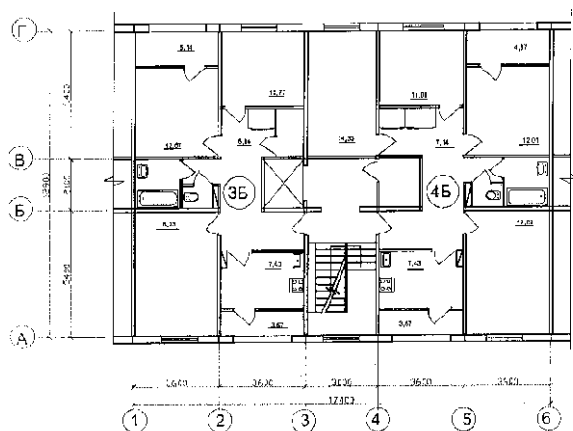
План типового этажа крупнопанельной конструкции серии 158
